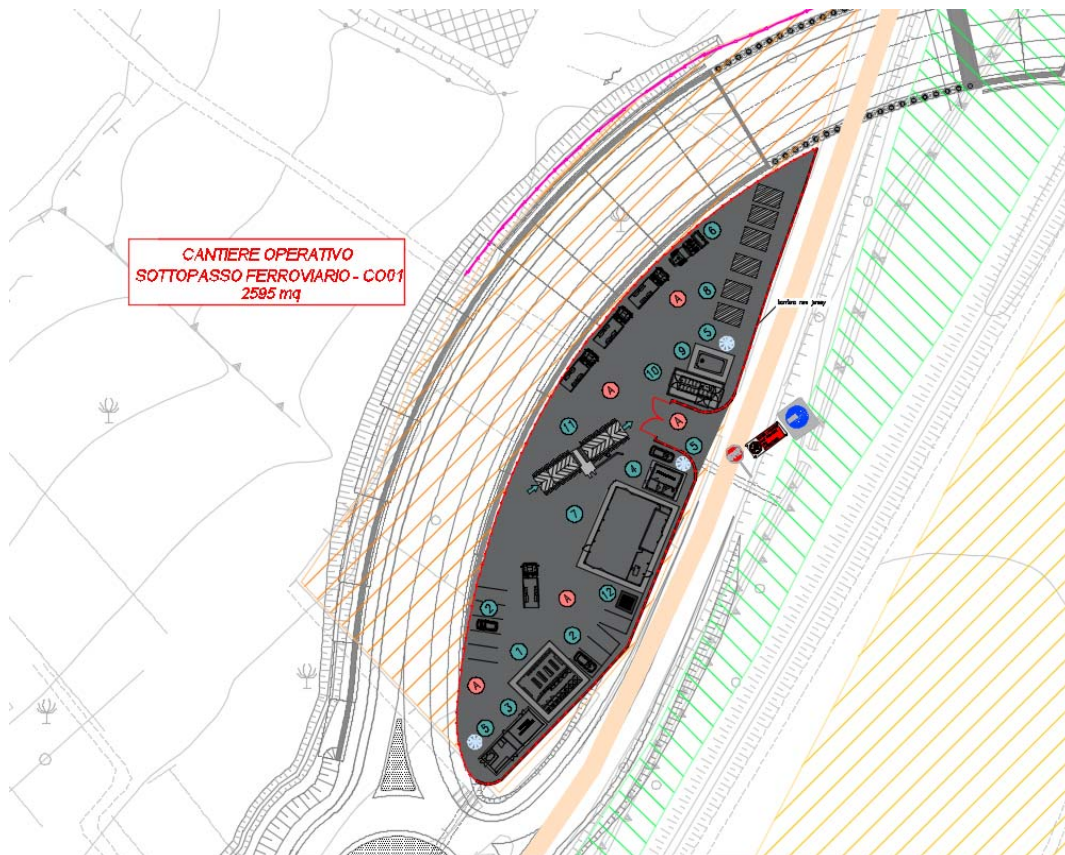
AREA CANTIERE SOTTOPASSO FERROVIARIO
